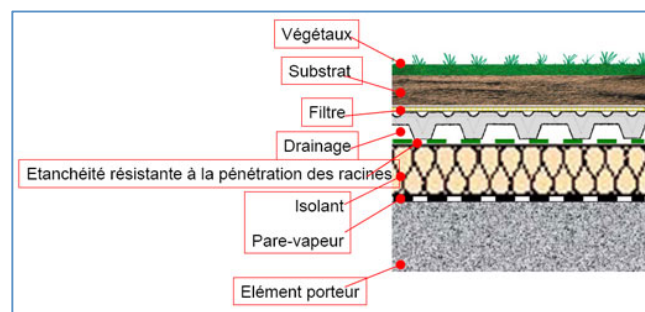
Coupe de principe d'une dalle (toiture) végétale [Site architecteo.com]
